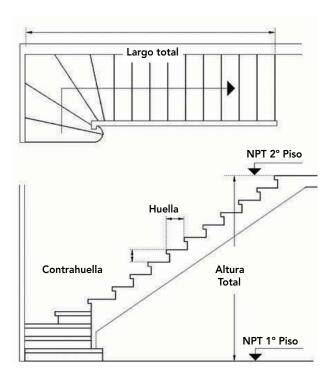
3: Planta y elevación tipo de una escalera de un tramo con arranque de un cuarto de vuelta y peldaños compensados.
